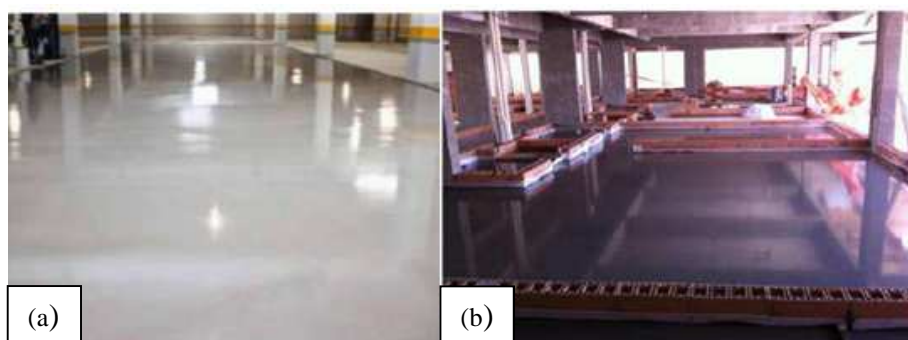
(a) Área de estacionamento com o contrapiso autonivelante industrial aplicado; (b) Pavimento com aplicação de contrapiso autonivelante, sobre manta acústica.
